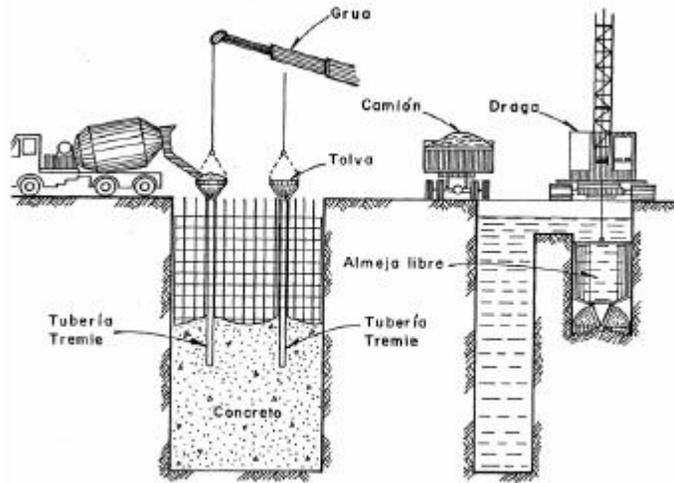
Secuencia de construcción de tableros para muros Milán
